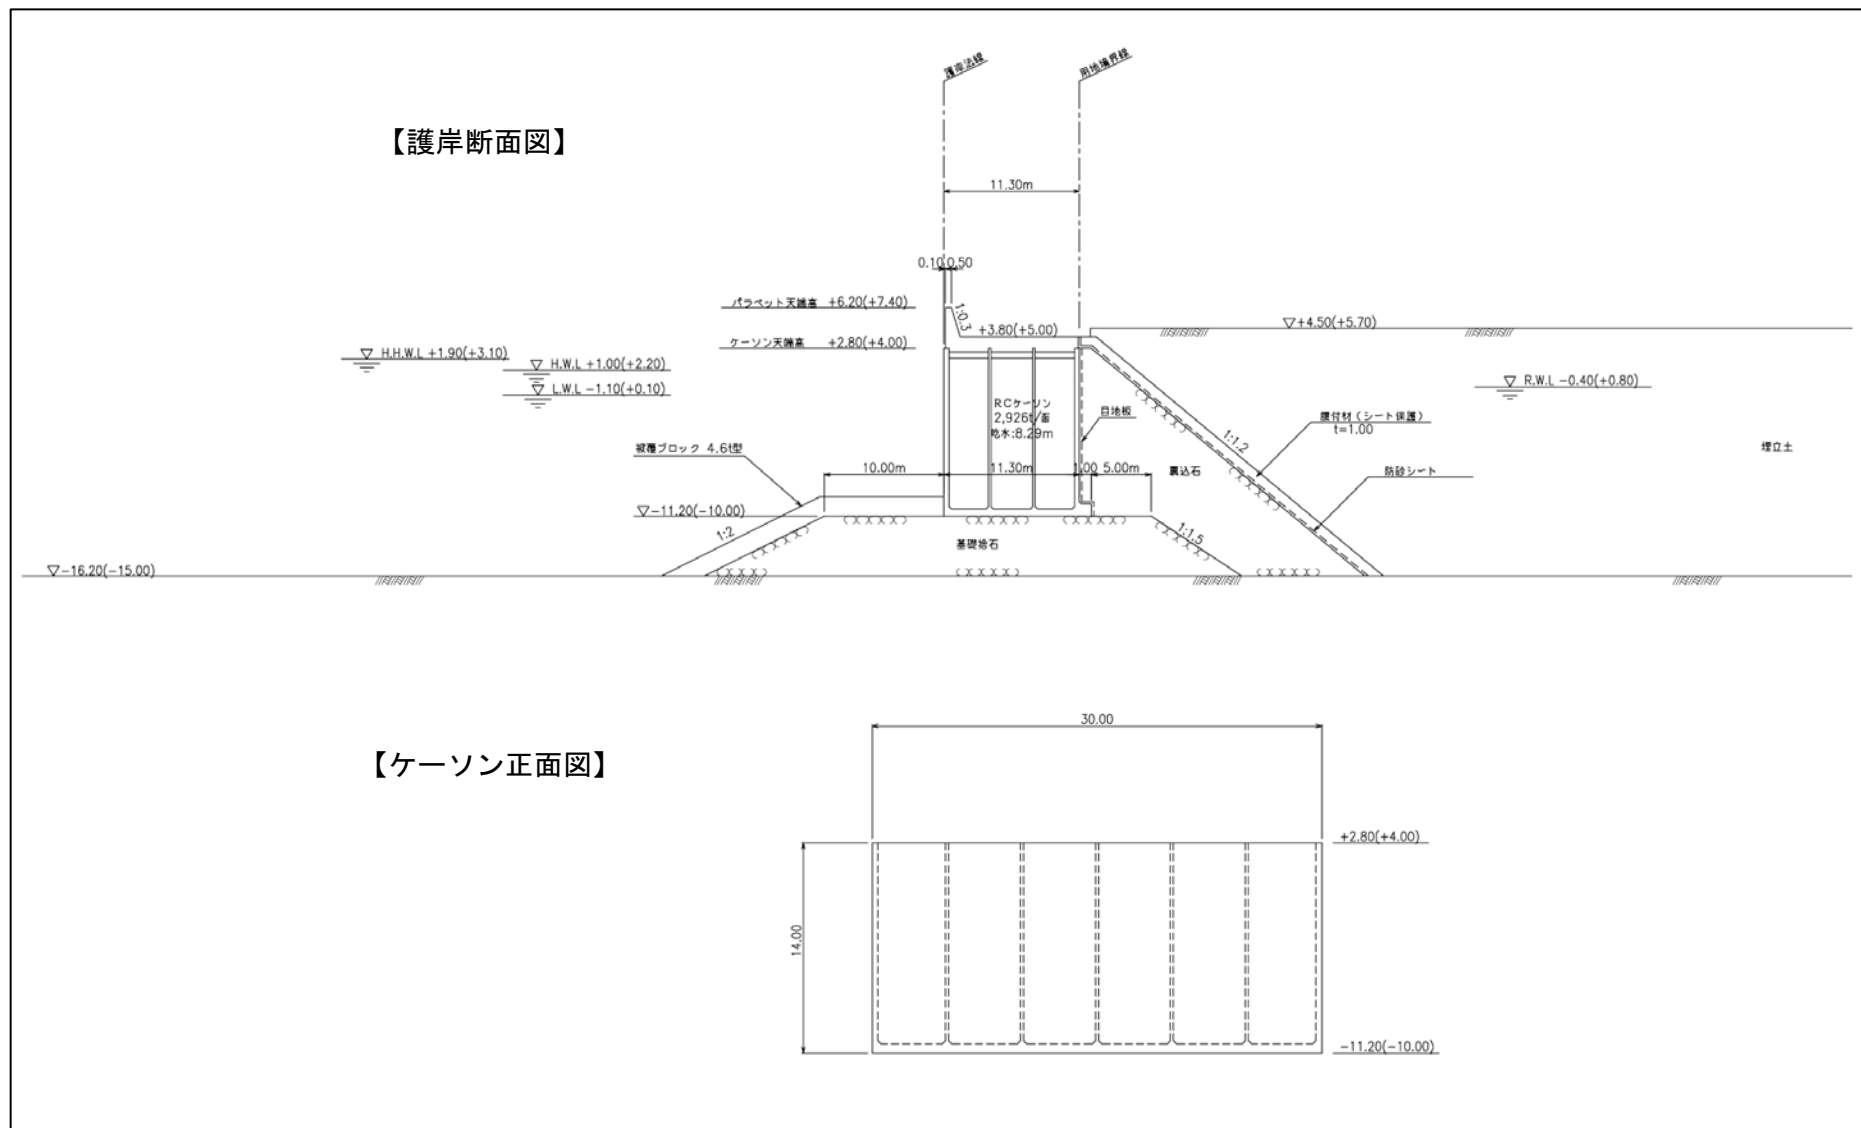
(4) 代替施設本体のケーソン式護岸断面図及びケーソン正面図 (隅角部)
